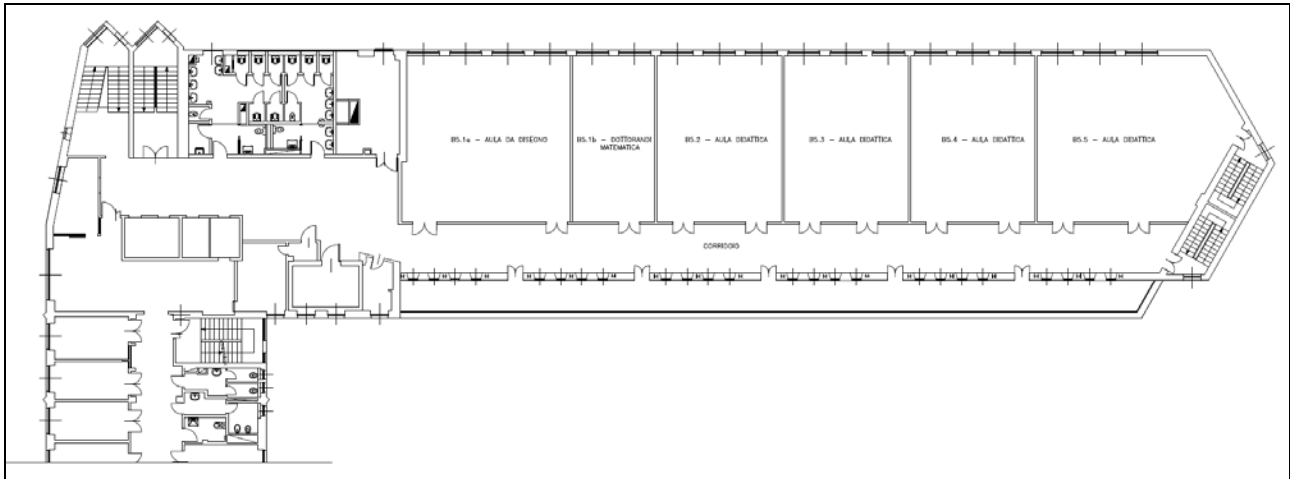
Planimetria del piano 5° dell'Ala Aule dell'Edificio 14
